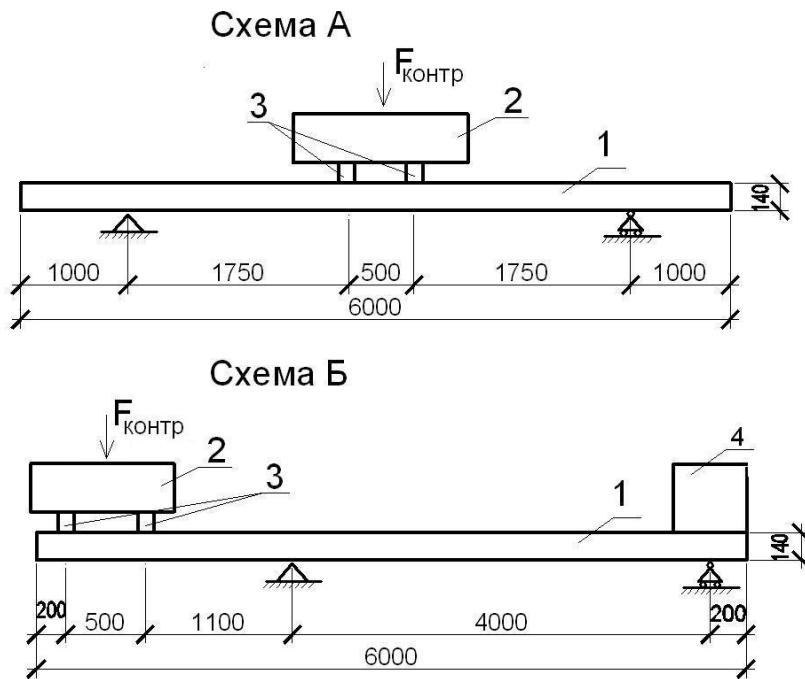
Схема испытаний: 1 – испытуемая плита; 2 – нагрузка на всю ширину плиты; 3 – деревянные брусья 100x100 мм или двутавры 12; 4 – пригрузочный балласт (≈200кг)
